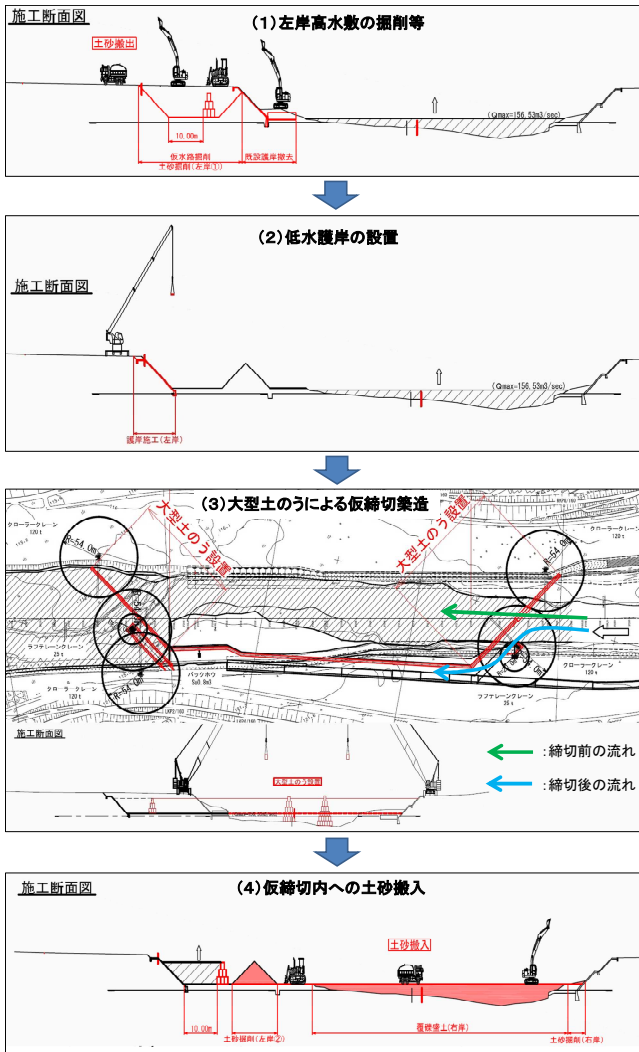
施工手順（公示図面の仮設の参考図 撤去の図は省略）
